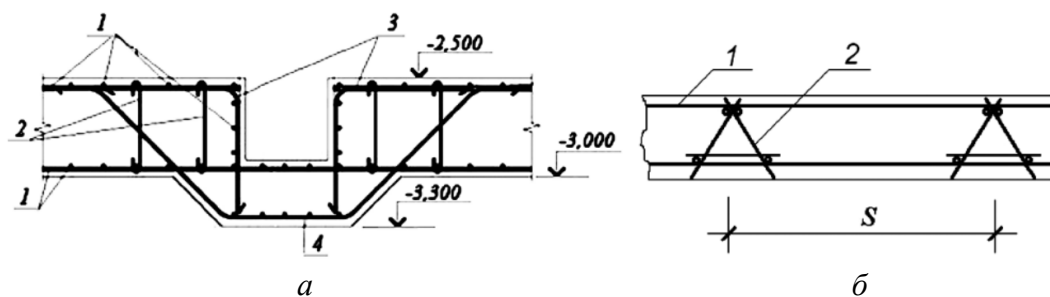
Пример армирования сплошной фундаментной плиты:
